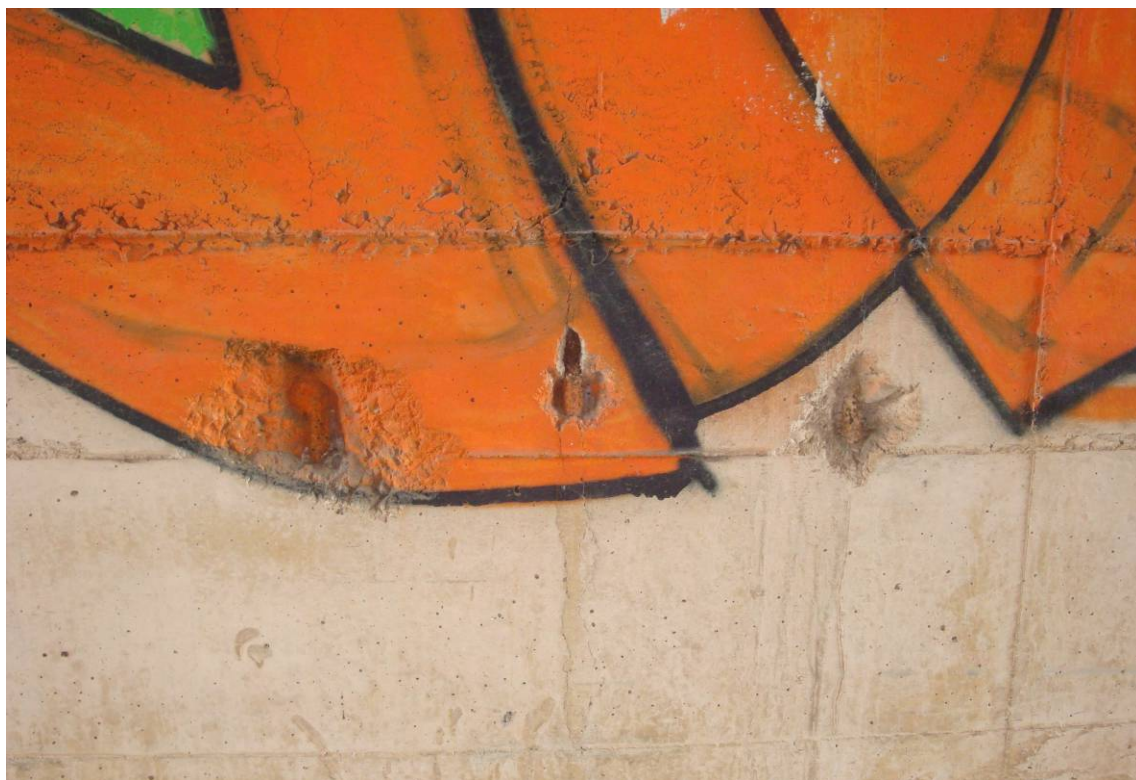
Muro frontale della spalla – particolare saggi conoscitivi
